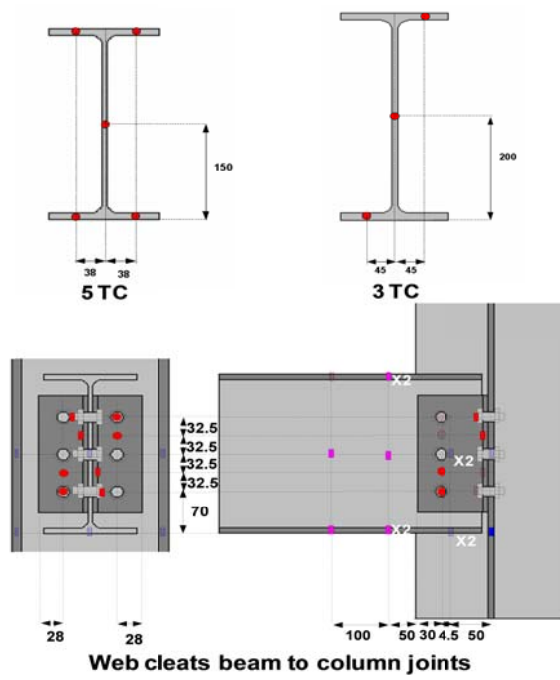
Position des thermocouples sur chaque section droite des pièces d'acier instrumentées
